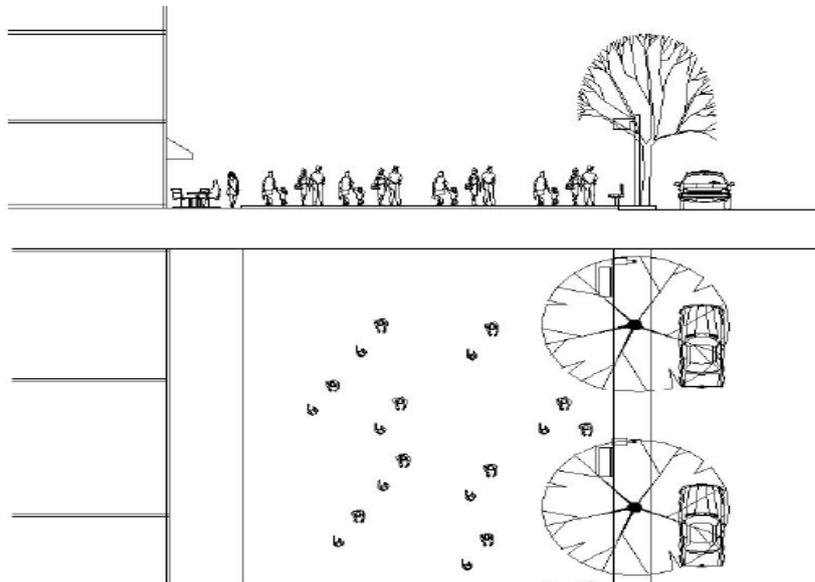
Tampak atas dan Potongan *sidewalk
